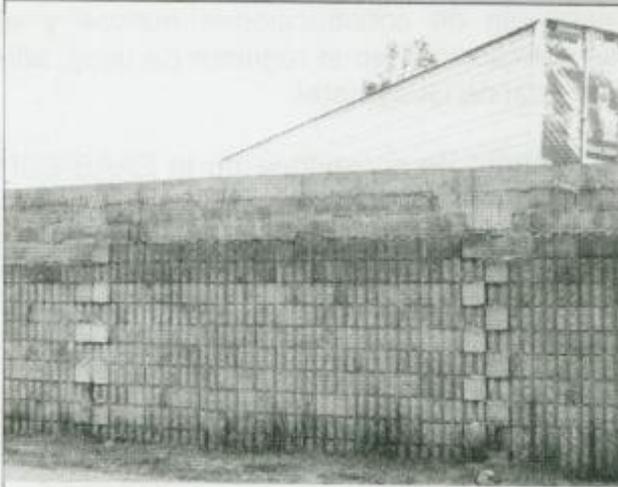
Muro de cerramiento en bloques de concreto en el predio en mención
